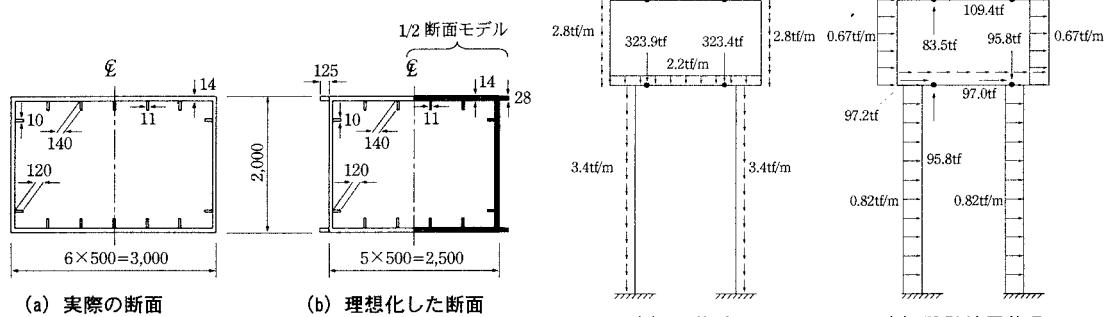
実際の断面、および理想化した断面（寸法単位：mm）
